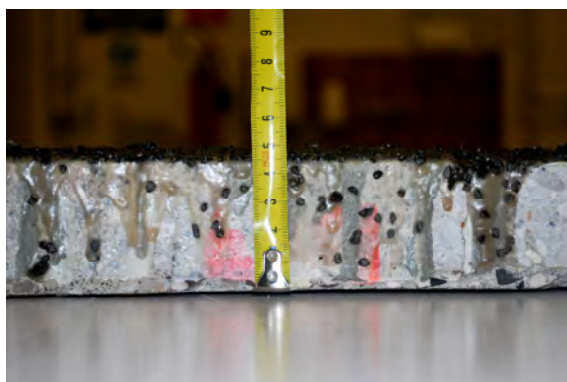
Prospetto laterale lastra in calcestruzzo da 5 cm con soluzione C sopra.
